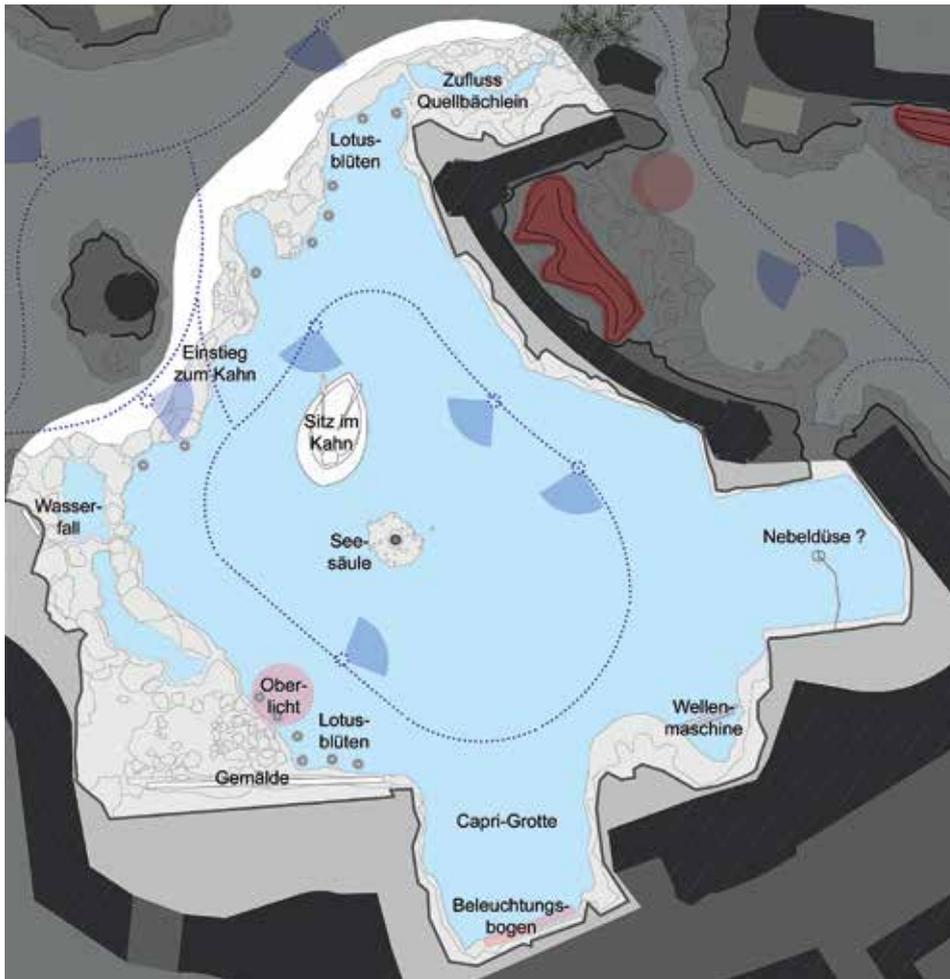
Seegrundriss mit verschiedenen Blickpunkten
